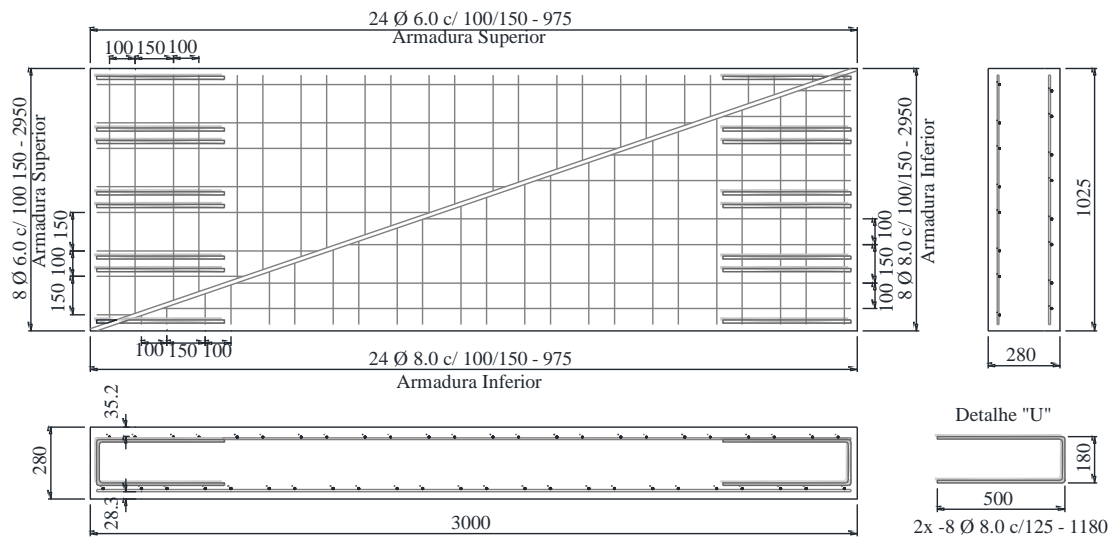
Detalhamento das armaduras de flexão da laje RSF28 (dimensões em mm).
